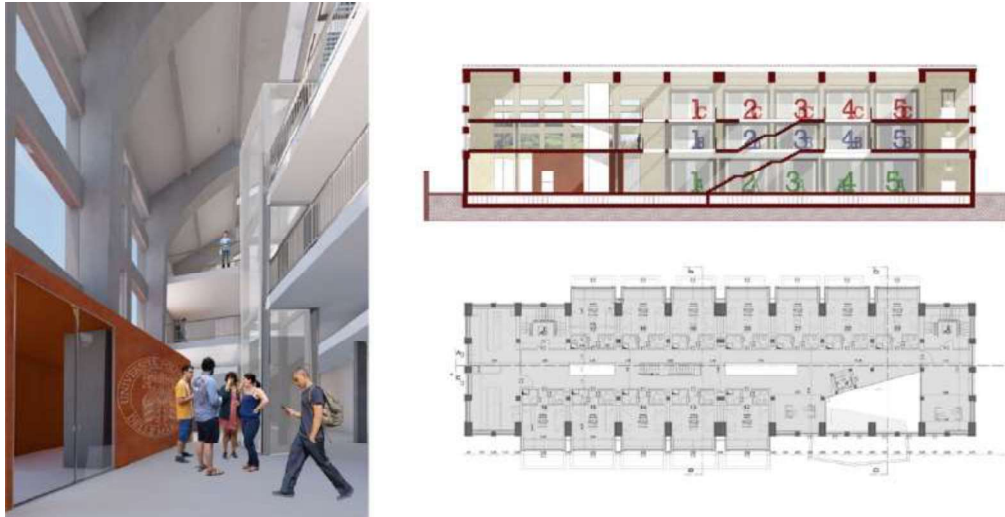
| Pianta tipo, sezione longitudinale e vista interna ingresso principale.
